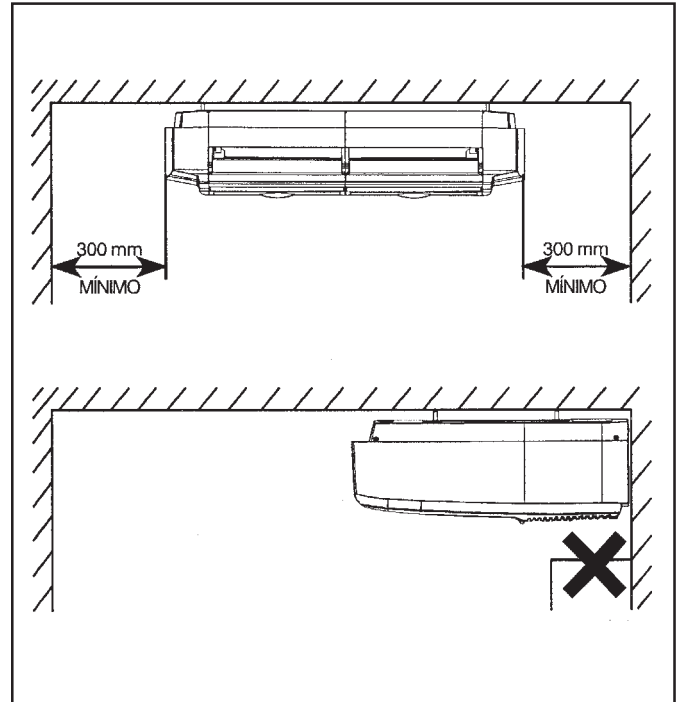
MONTAGEM TETO - UNDER CEILING
